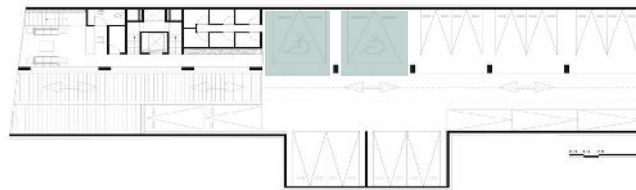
Estacionamientos para incapacitados. Planta Baja
